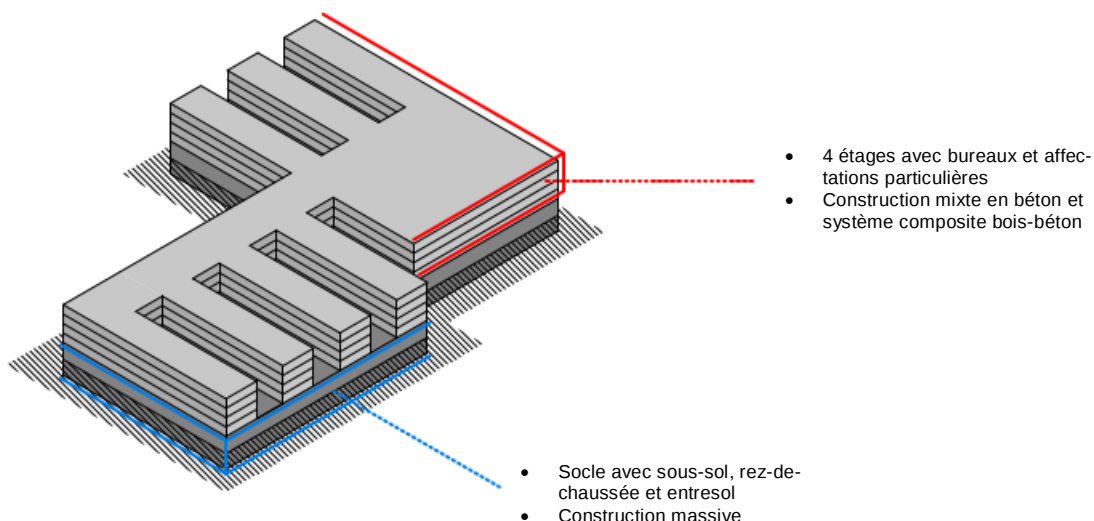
Nouveau CPB constitué d'un socle (avec un sous-sol, rez-de-chaussée et entresol) et de locaux de bureaux / locaux techniques (combles)
